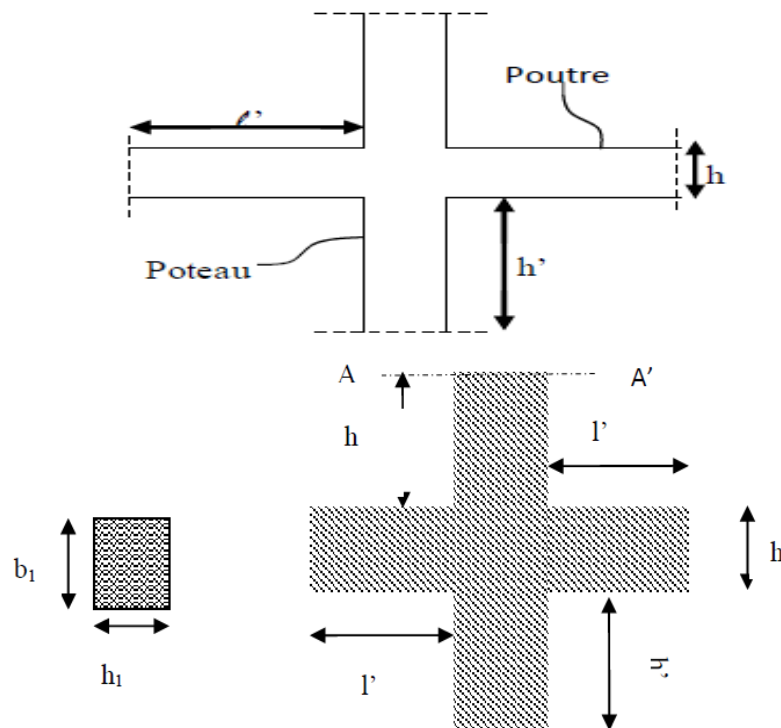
Zone nodale (nœud poutre-poteaux)
